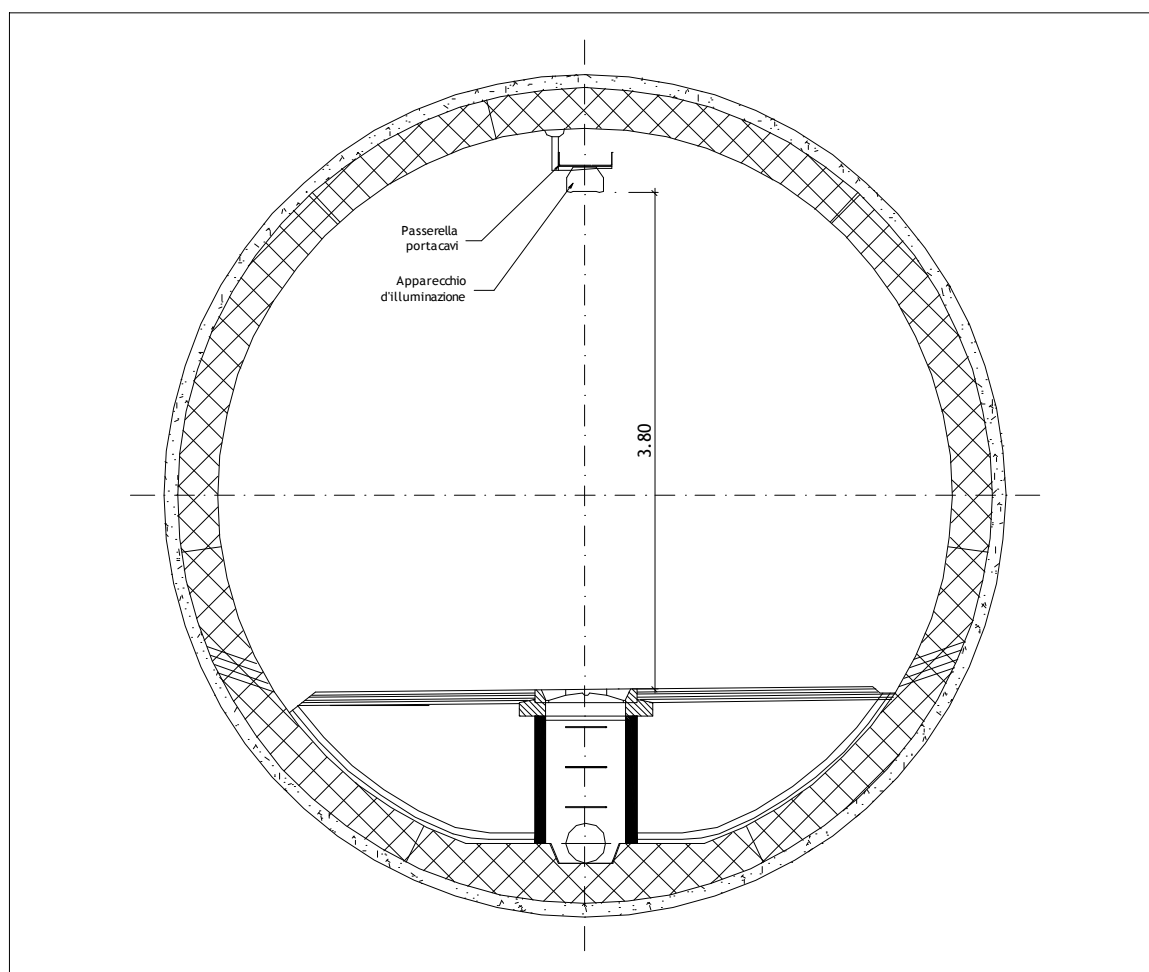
Illuminazione della galleria di sicurezza - Sezione tipo
